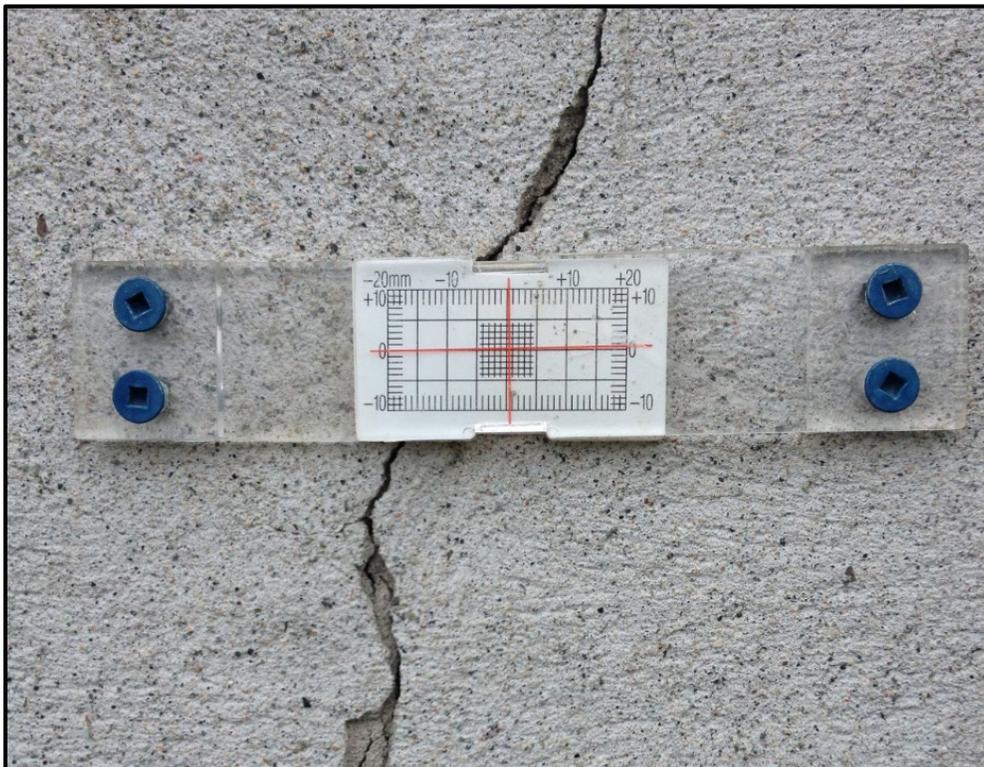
Fissuromètre installé sur le mur d'un bâtiment de la ville de Malartic
